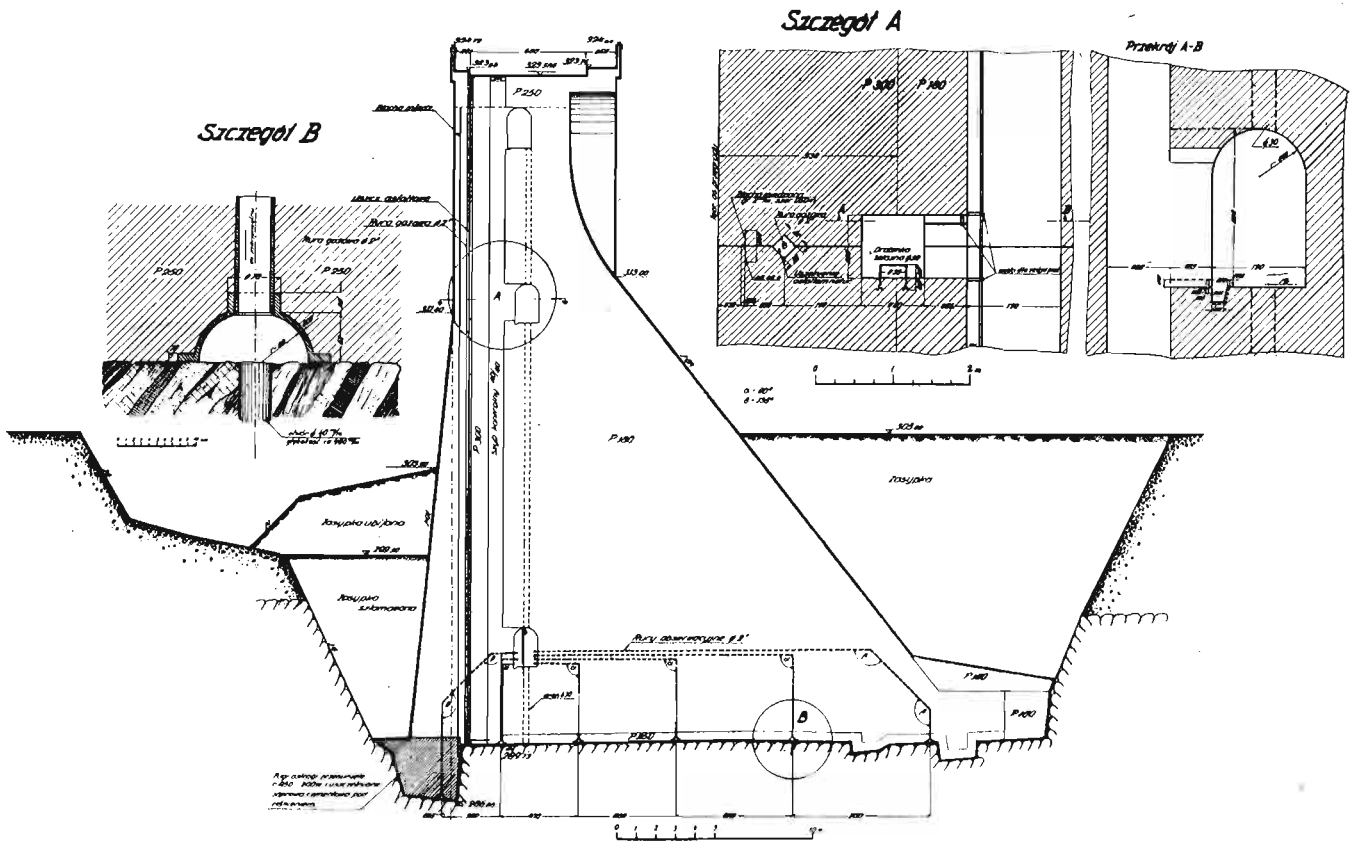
Centralna stacja pomiarowa dla dilaterometrów w galerii wyjściowej bloku 15.
